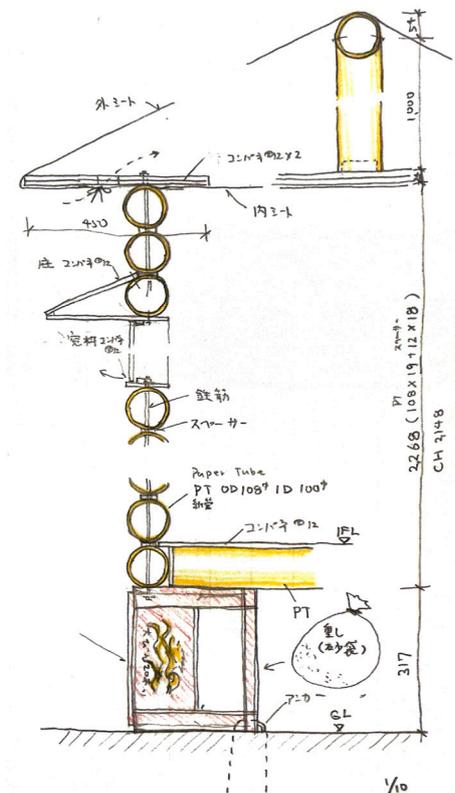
Sección constructiva del diseño de la Paper Log House, modelo de Japón.
